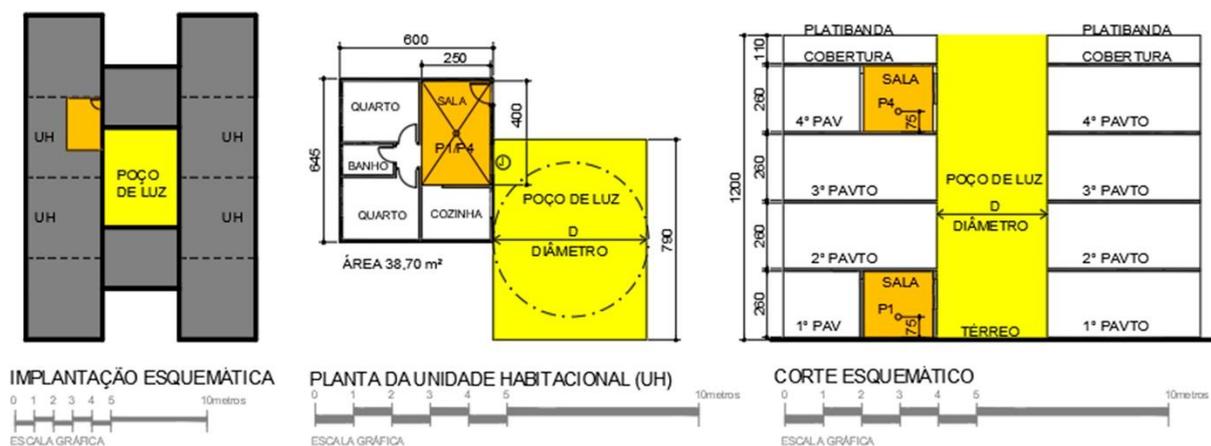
Modelo de análise: Implantação esquemática, planta da unidade habitacional (UH) e corte esquemático.
